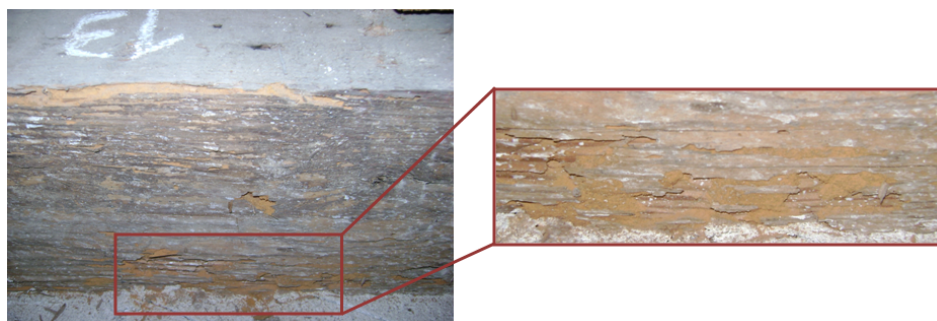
Aspecto de degradação da Viga 13 do pavimento (Face orientada para Sudeste)
